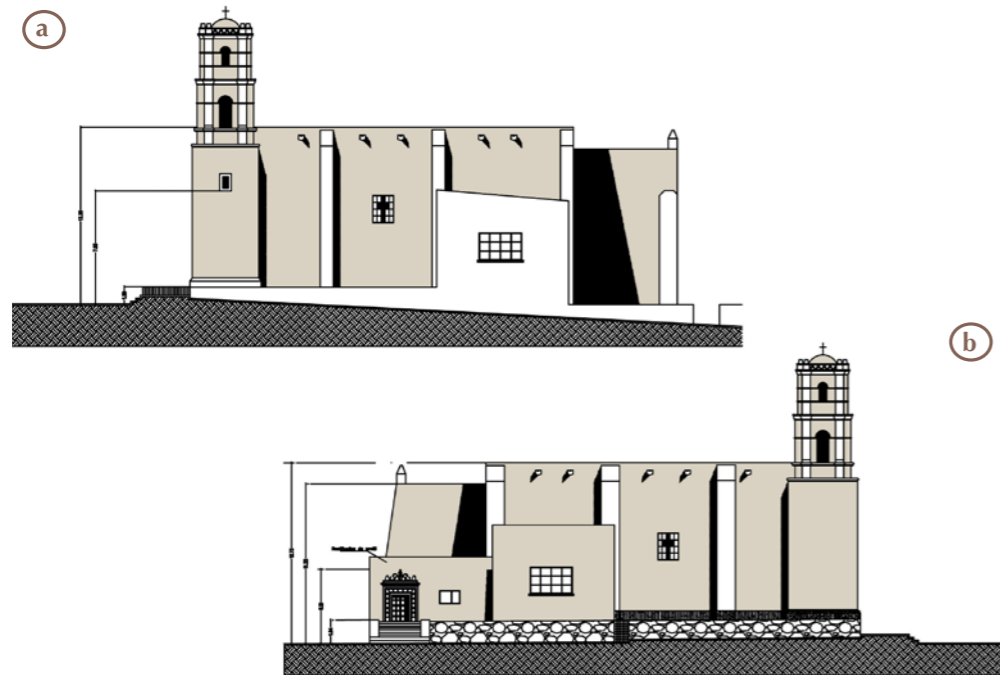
28. Alzados arquitectónicos del templo. Corte fachada Norte (a); corte fachada Sur (b). (Dibujos: Misiones Coloniales de Chihuahua A.C., 2007).
